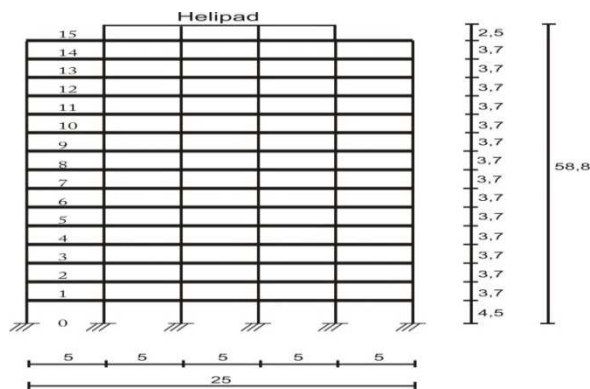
Denah Lantai 1 s/d Lantai 15
